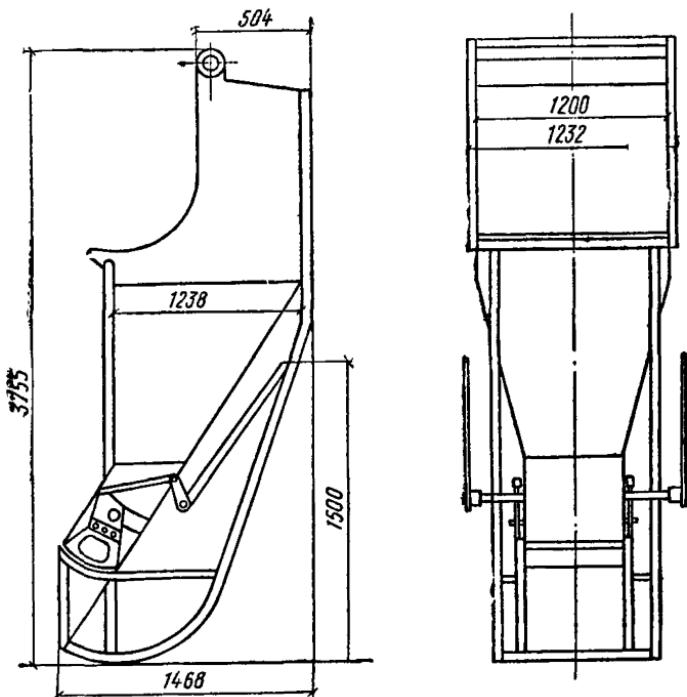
Бадья с боковой выгрузкой бетонной смеси
